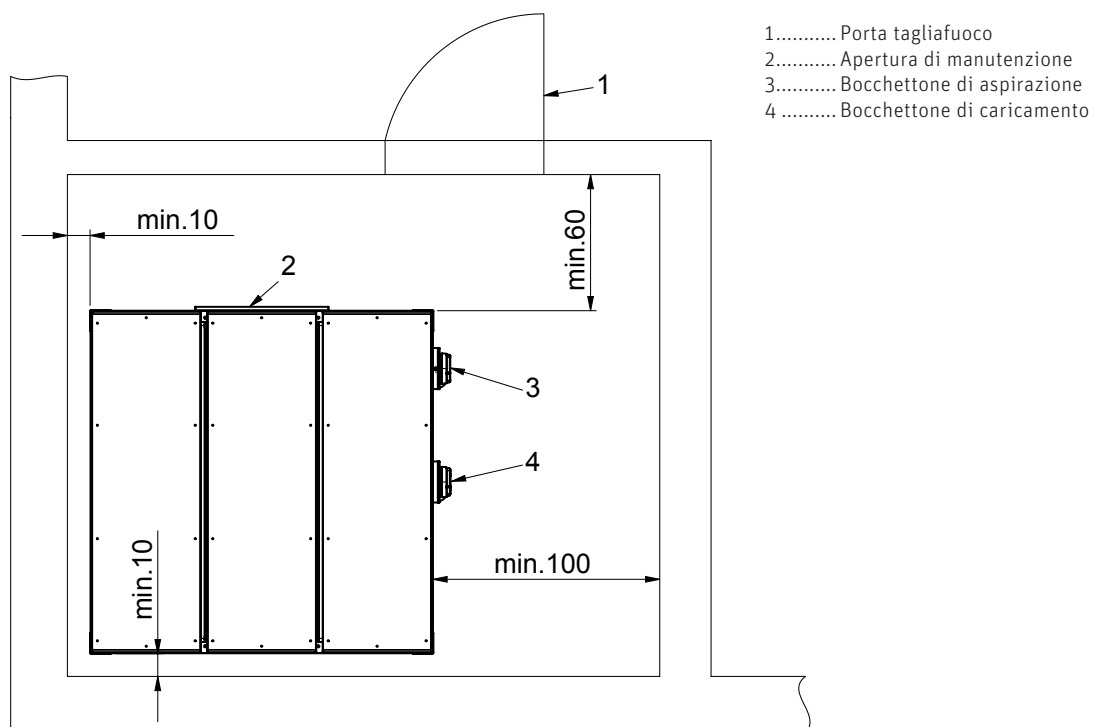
Vano di installazione e serbatoio in lamiera d'acciaio – vista dall'alto
